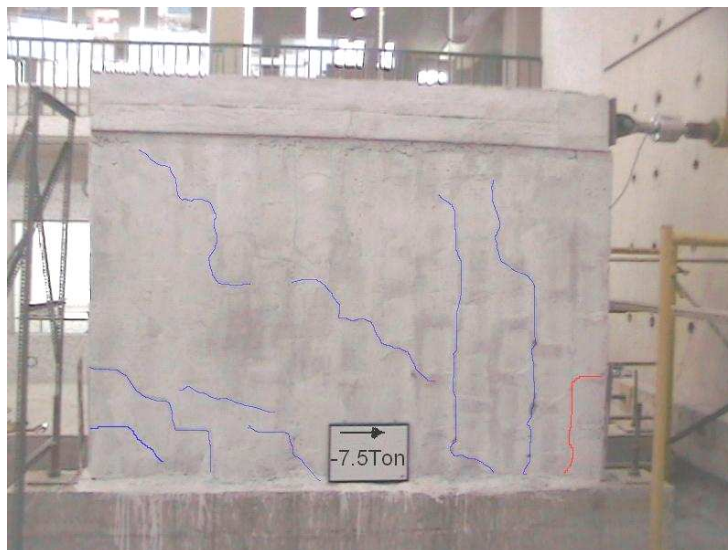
Pequeñas Fisuras de corte y fallas más notables en la unión de los bloques
